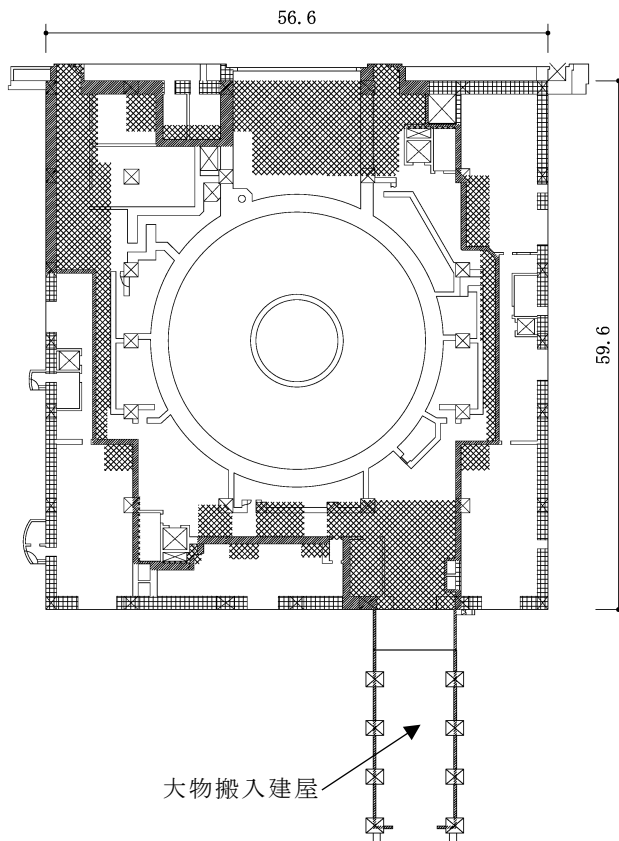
二次遮蔽壁及び補助遮蔽の範囲の平面図
